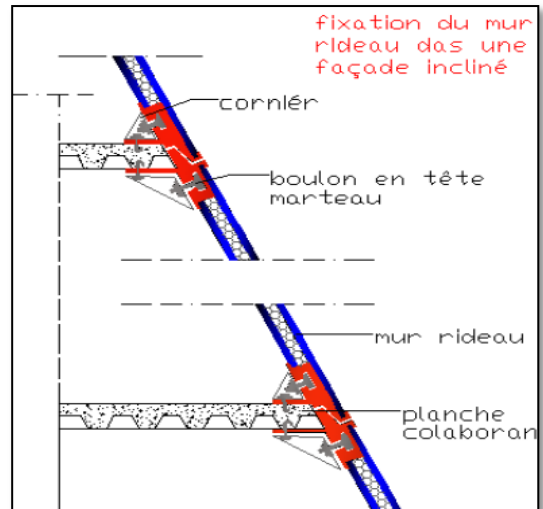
fixation d'u mur rideau incliné sur plancher collaborant source: auteurs
